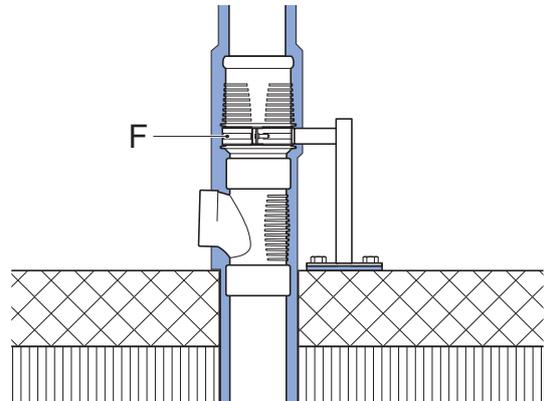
Fixpunkt mit Konsole auf der Betonschicht der Holz-Beton-Verbunddecke
